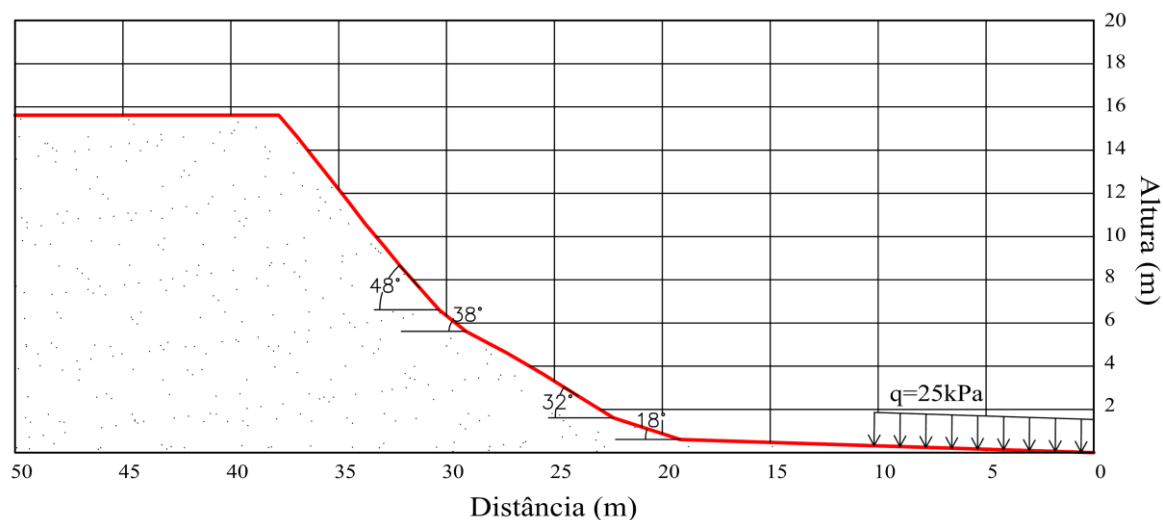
Planta Planialtimétrica da Encosta do Setor 01.
